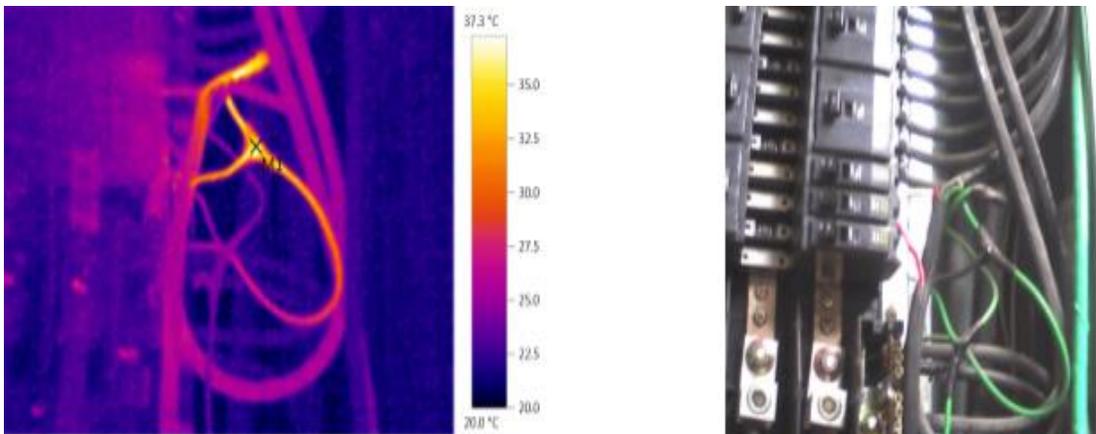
Tablero Principal Edificio I Planta Alta
